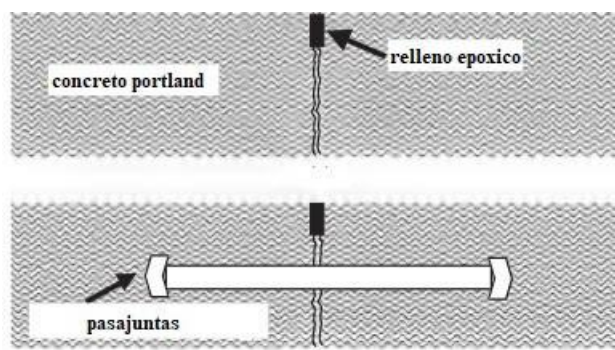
Pasajuntas en losa de concreto. Fuente: Elaboración propia a partir de (Papagiannakis et al., 2008)
